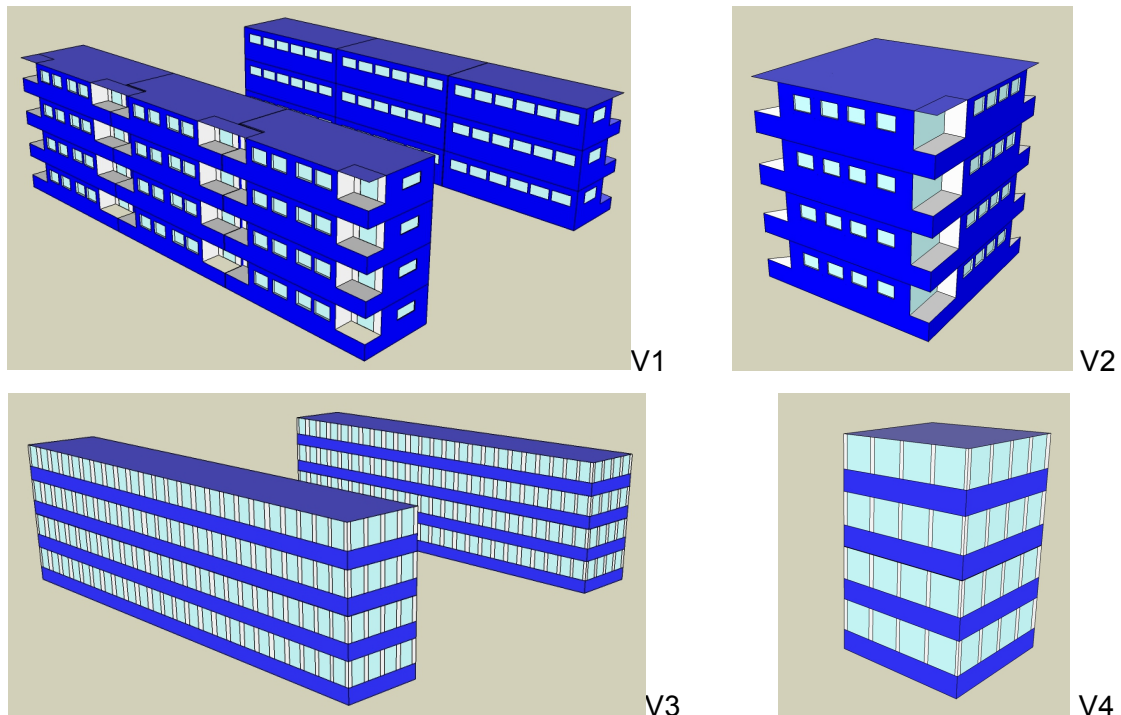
Schematische Darstellung der Fassadenansichten der vier betrachteten Varianten. Das Dach und die dunkelblauen Flächen der Fassaden sind mit Photovoltaik bedeckt.
